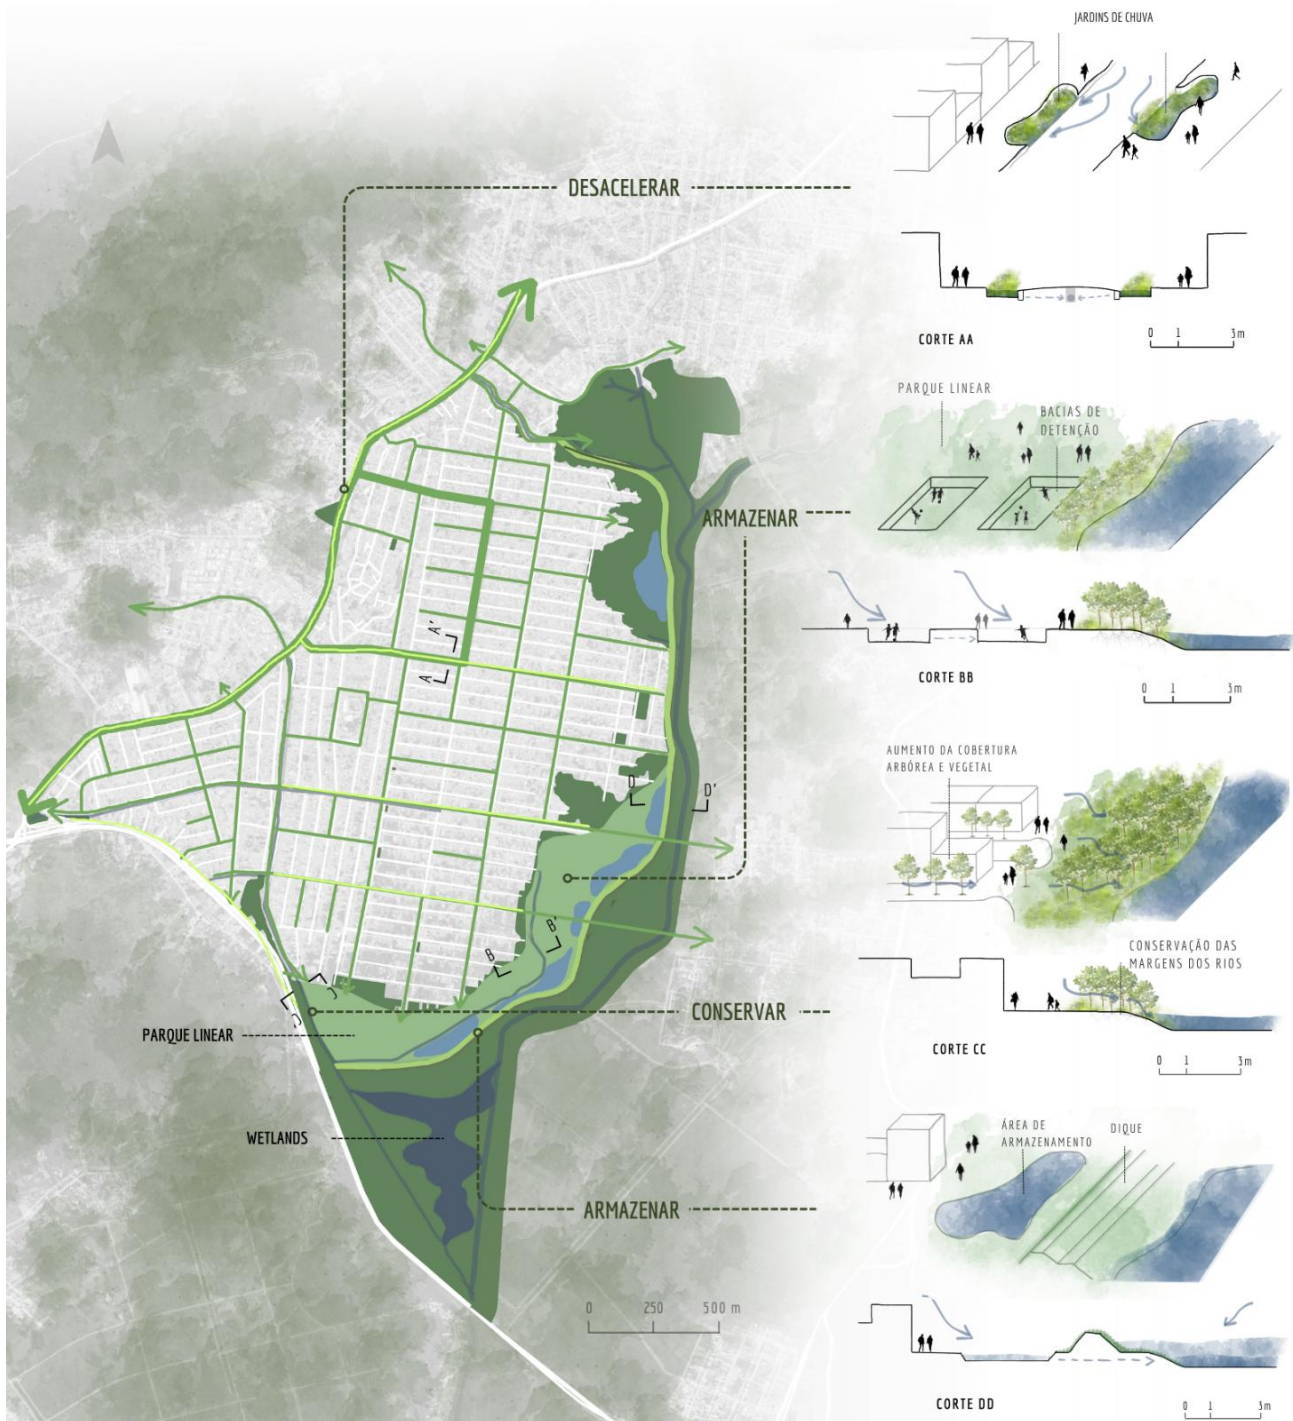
Plano Geral proposto para o Loteamento Jardim Maravilha com Infraestrutura Verde e Azul.
